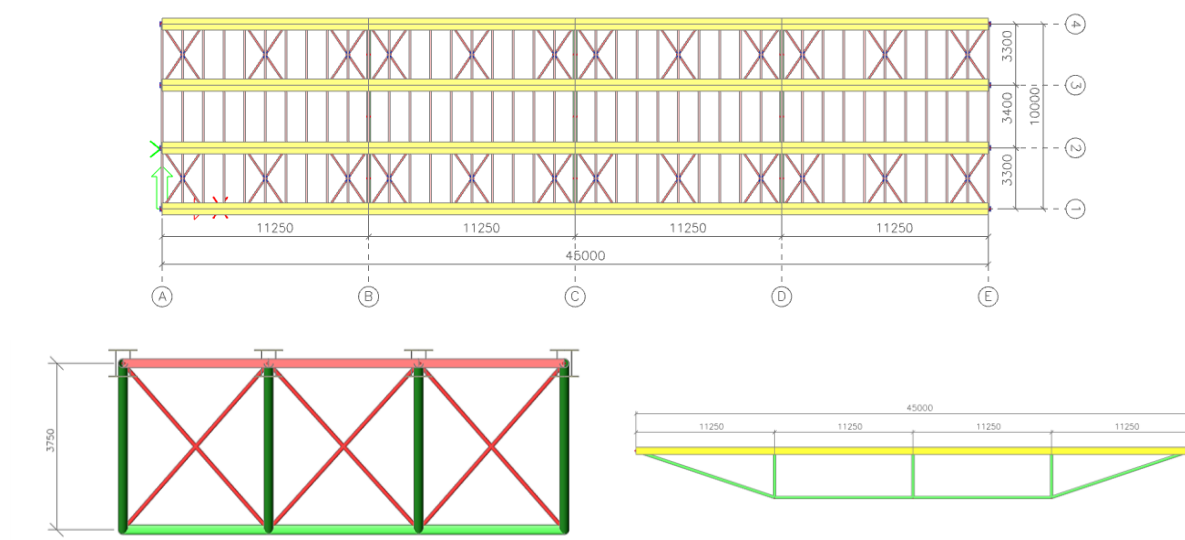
Modelo estrutural de viga vagão, Vista Superior, Frontal e Lateral.
